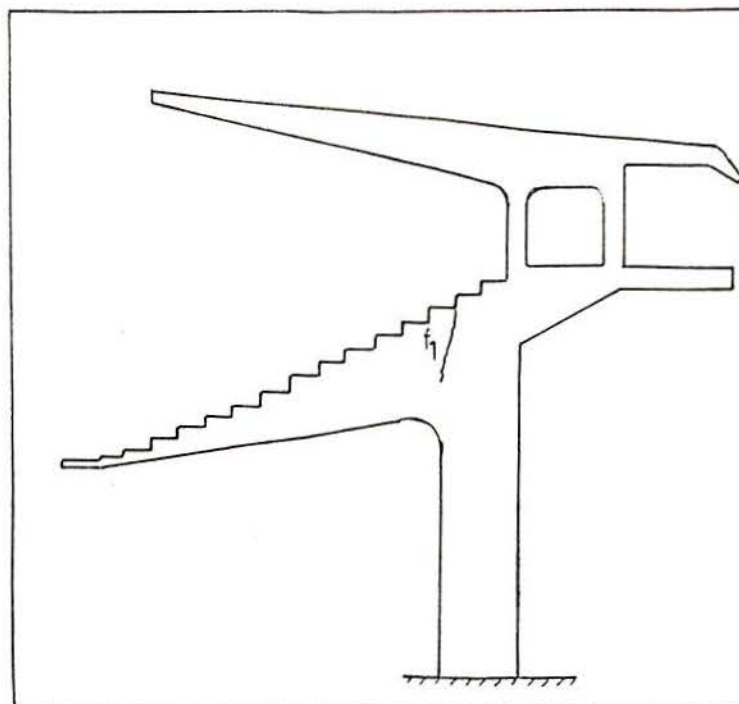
Esquema de fissuras no pórtico 2 para 8 KN.
